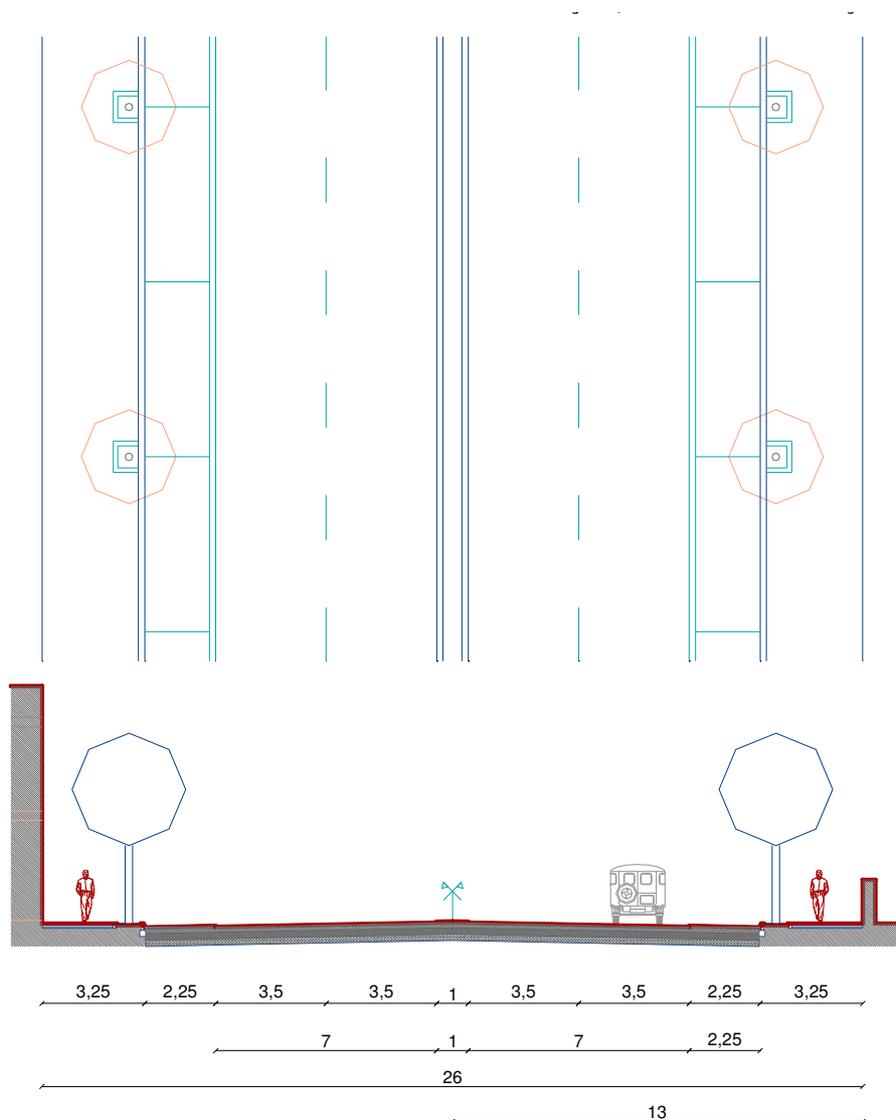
Perfil Transversal Tipo para as vias de sentido duplo (PT2) em áreas de Habitação, Comércio e Serviços
